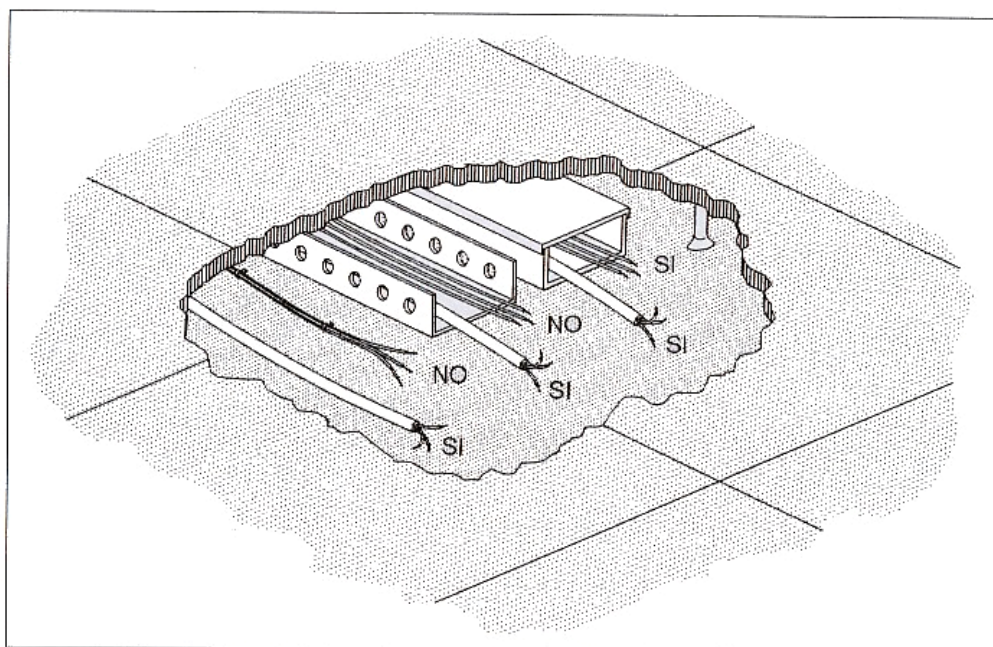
Sotto il pavimento galleggiante è ammessa la posa diretta solo dei cavi con guaina. I cavi senza guaina devono essere posati in tubi protettivi o canali (non sono ammessi nelle passerelle).
